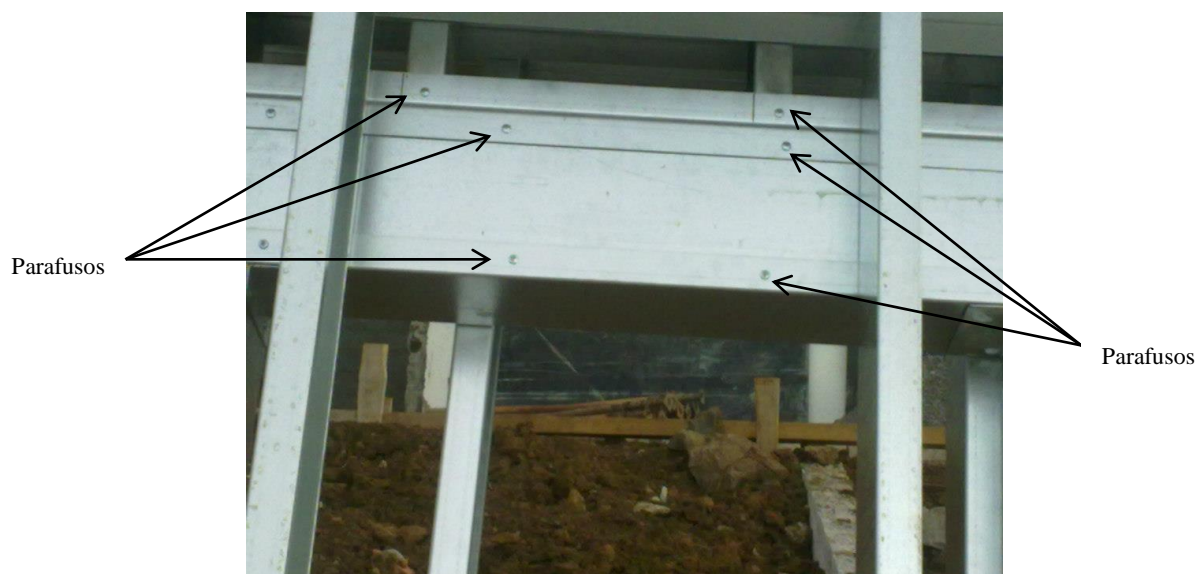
Estrutura em aço enformado a frio da obra da Lombada, Ponta do Sol (GoulartconstruçõesLda, 2013)
